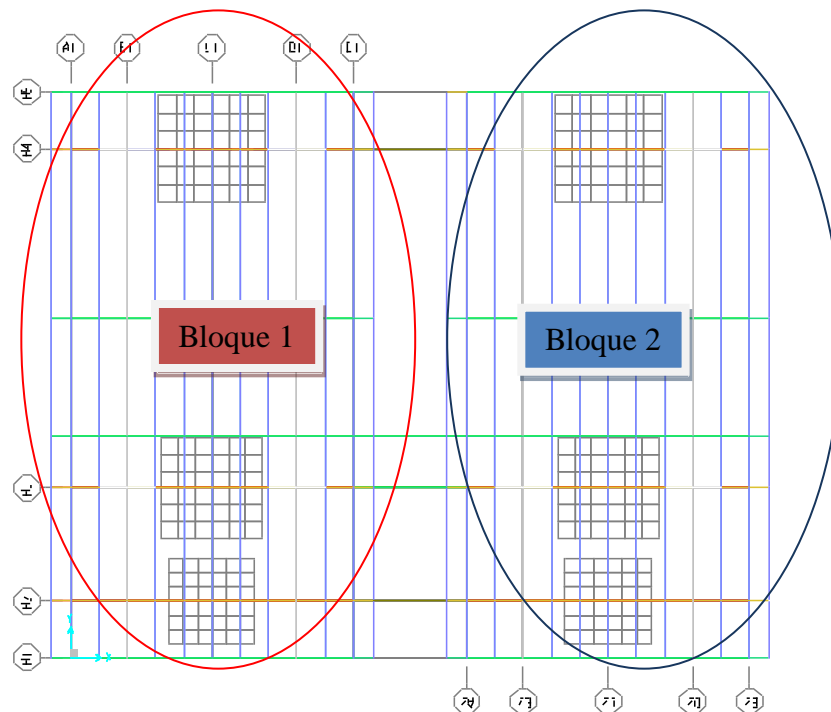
Planta del modelo, detalle de bloque de diseño.
